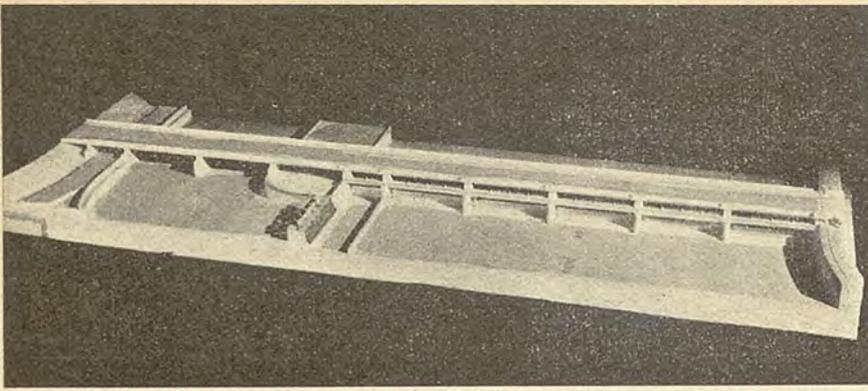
Impianto sul Po - Modello della traversa col ponte stradale
